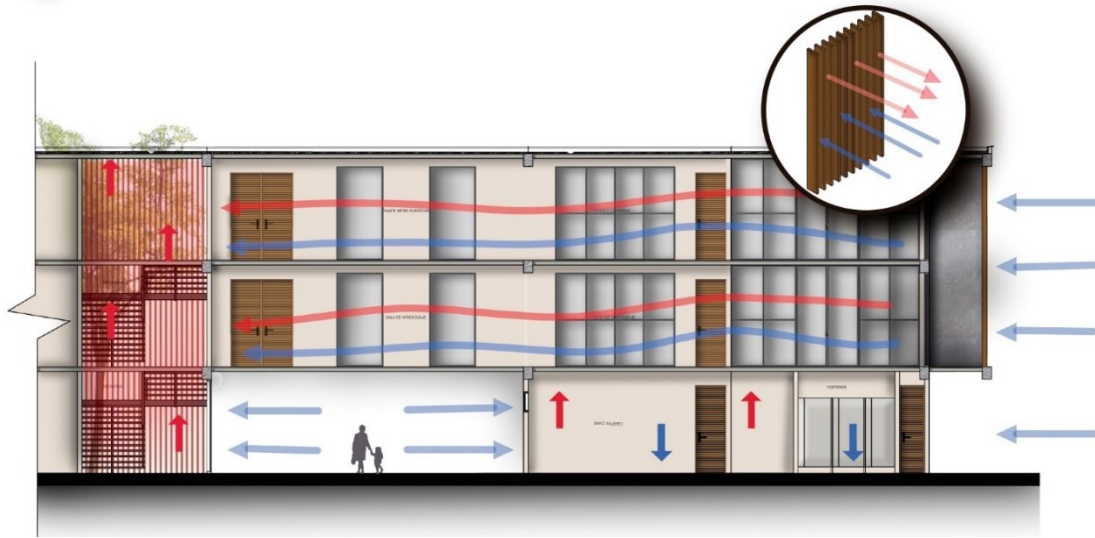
Corte Fachada. (Autoría propia 2022).
